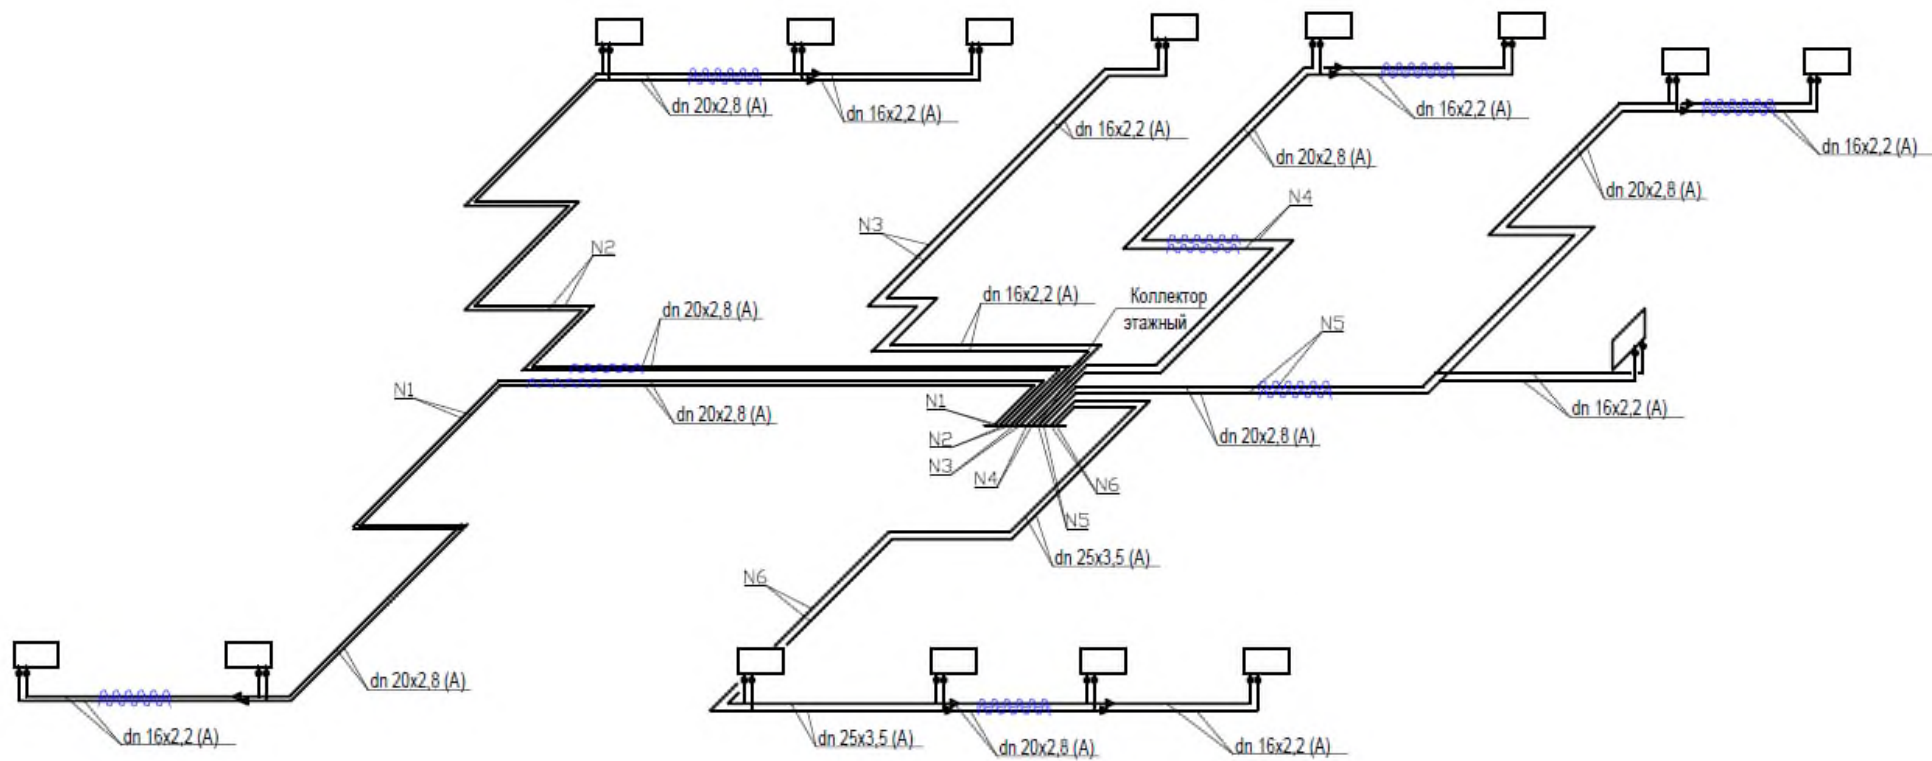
Расчётная схема системы отопления правой ветки жилого дома
